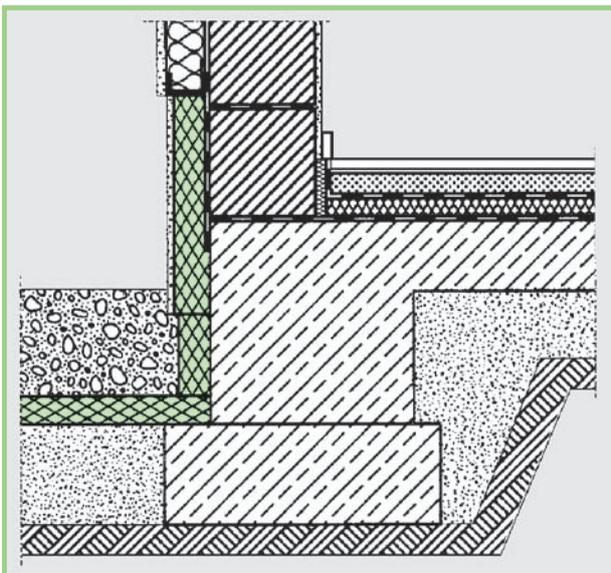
Possibilità di isolamento delle fondamenta contro il gelo.
